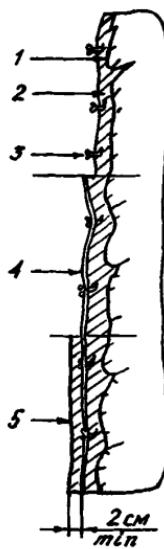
Крепление арматурной сетки вязальной проволокой:
